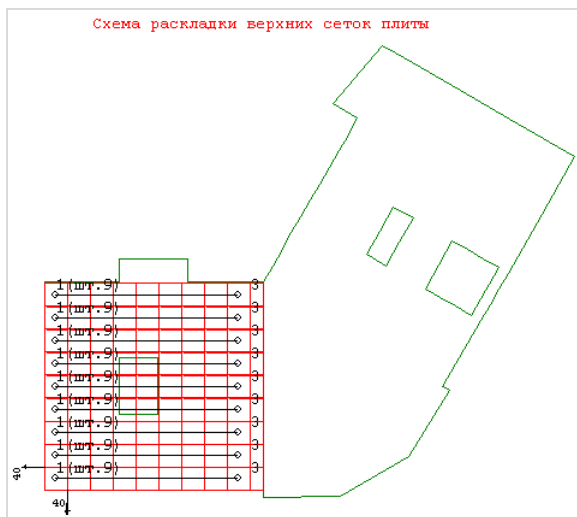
Схема раскладки сеток у верхней грани плиты, участок 1 (фрагмент)
